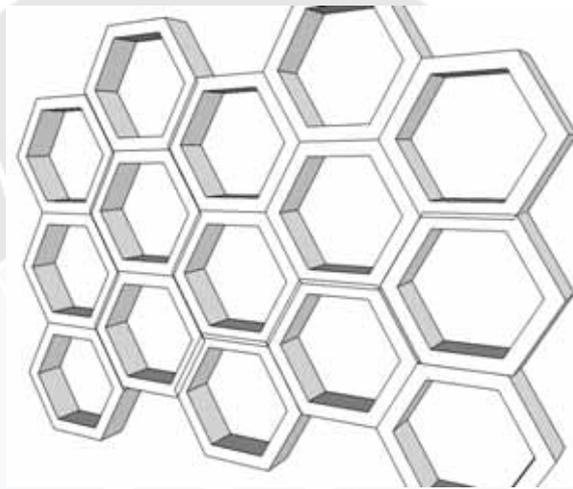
struktur sebagai pelingkup utama bangunan
